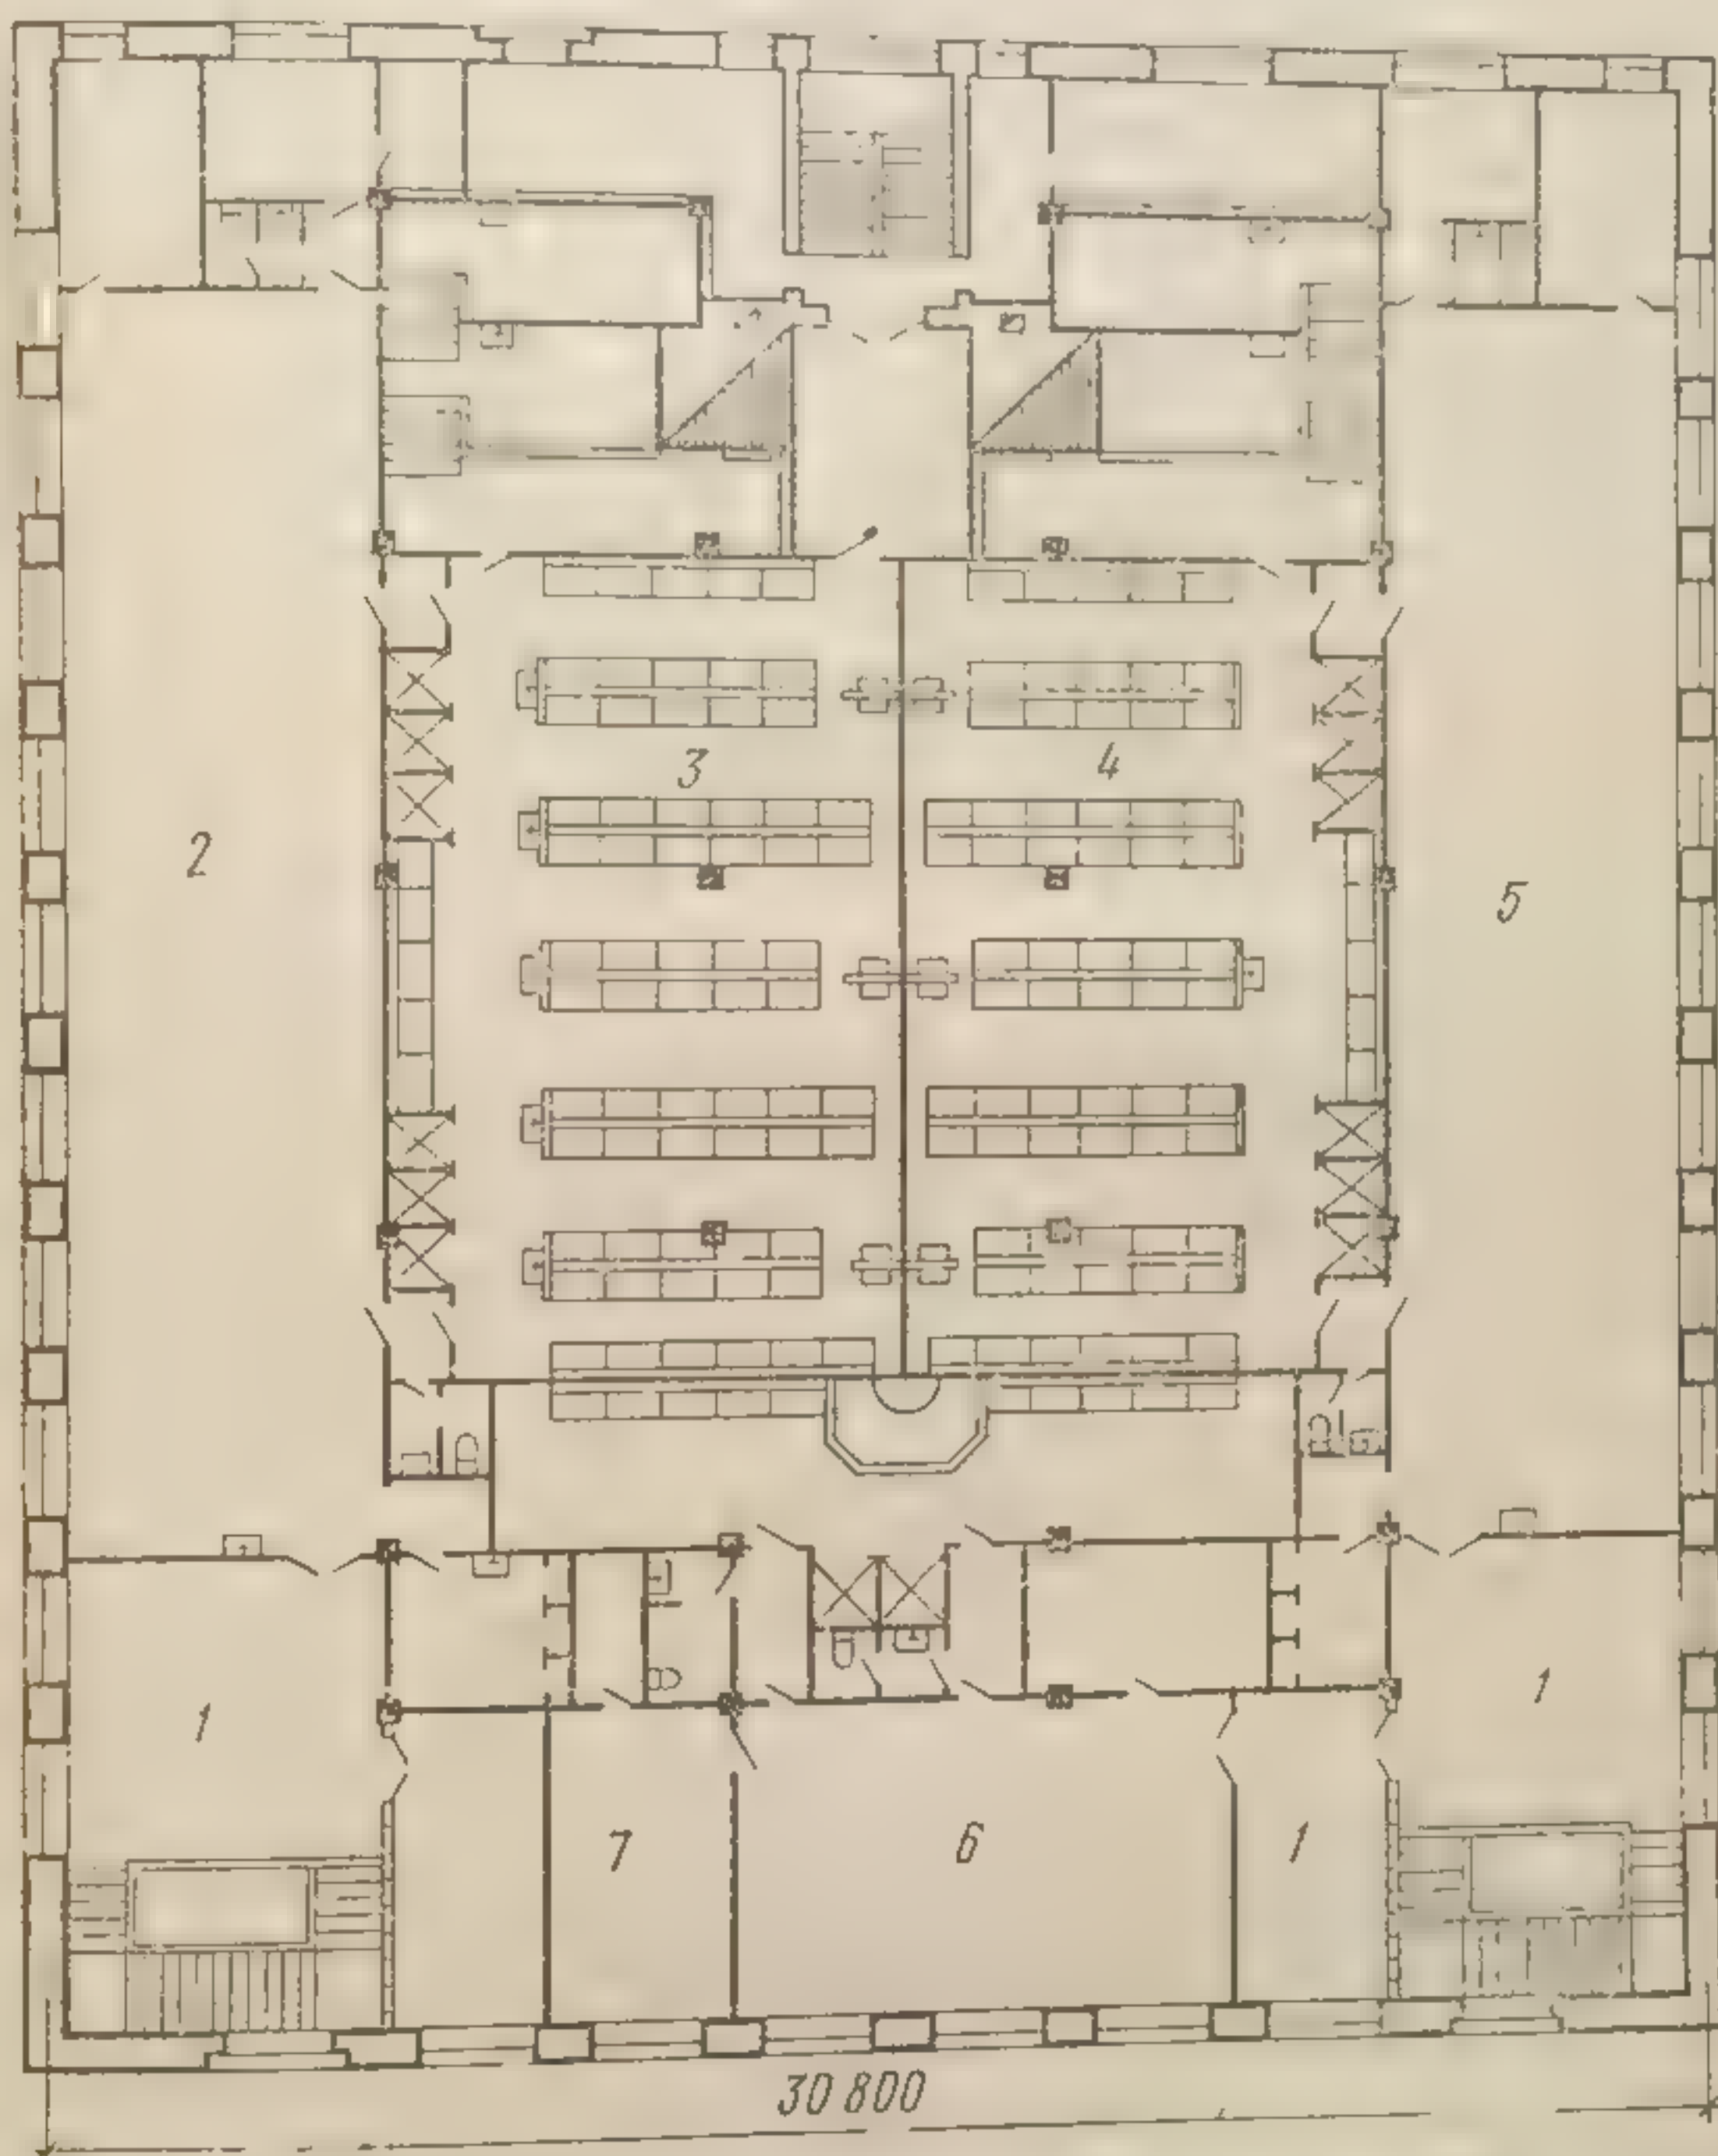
Типовой проект бани на 200 мест в Ленинграде. План второго этажа:
